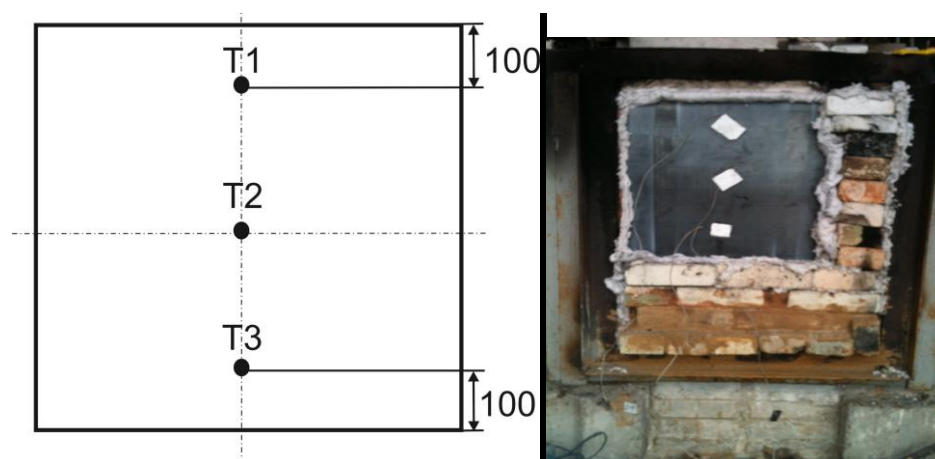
Схема размещения термопар с необогреваемой поверхности металлической пластины
